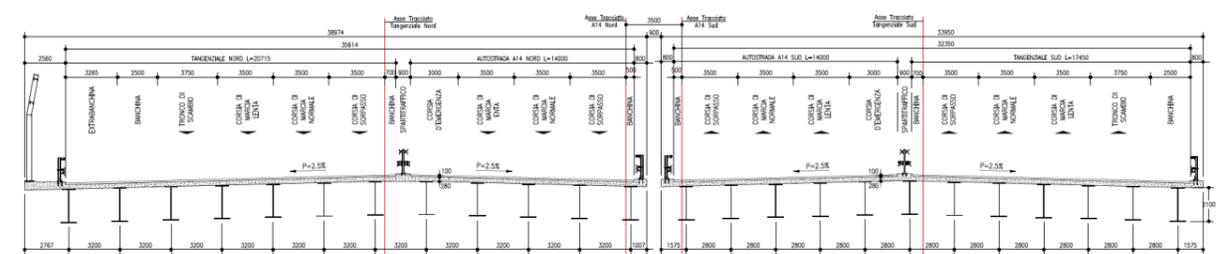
Sezione tipo trasversale di progetto ponte sul fiume Savena³³
